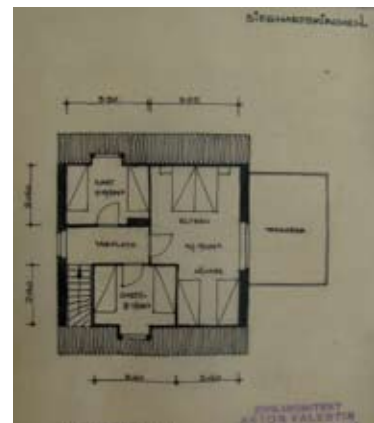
Plan 24.43: Anton Valentin. Sieghartskirchen. Grundriss Dachgeschoss. Ohne Datierung. Architekturzentrum Wien.
